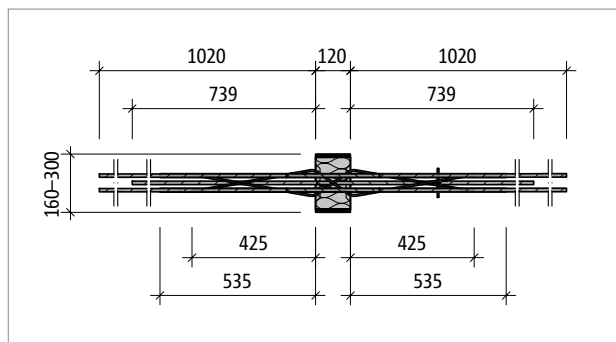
Schöck Isokorb® XT Typ WL-M4: Produktgrundriss
